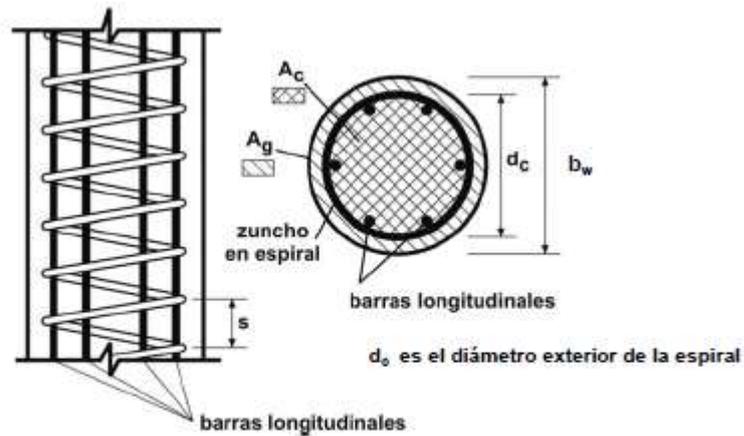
Armadura transversal en columnas (zunchos en espiral).
